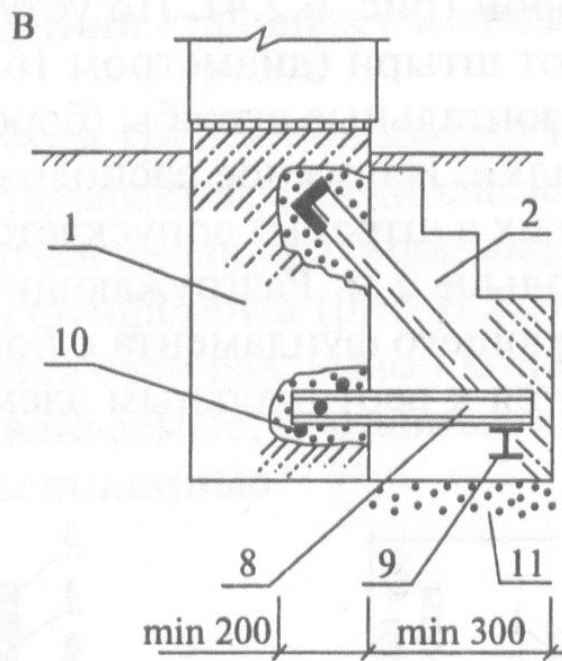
Увеличение опорной площади ленточных фундаментов с помощью приливов:
